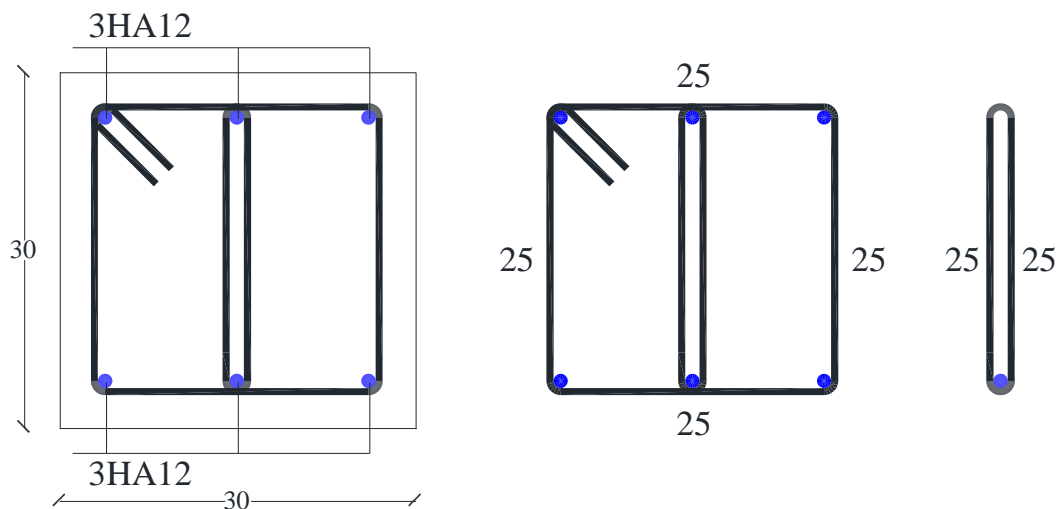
ferrailage de la section transversal du poutre palier
